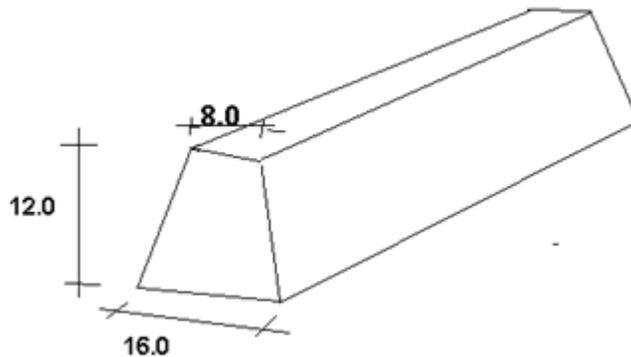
Sección tipo de bordillo de concreto hidráulico.
